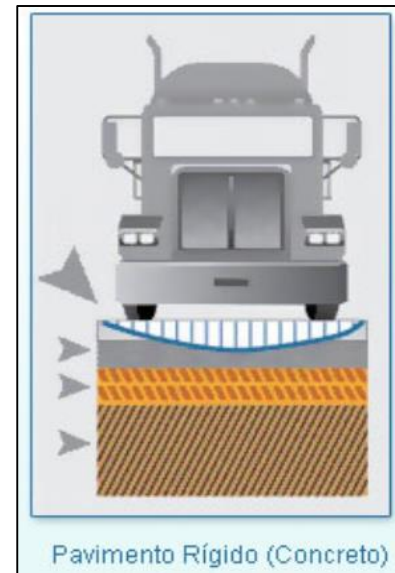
Distribución de Esfuerzos en la losa de concreto. (Recuperado de <http://www.duravia.com.pe/category/conoce-el-pavimento/page/2/>, s.f.)
